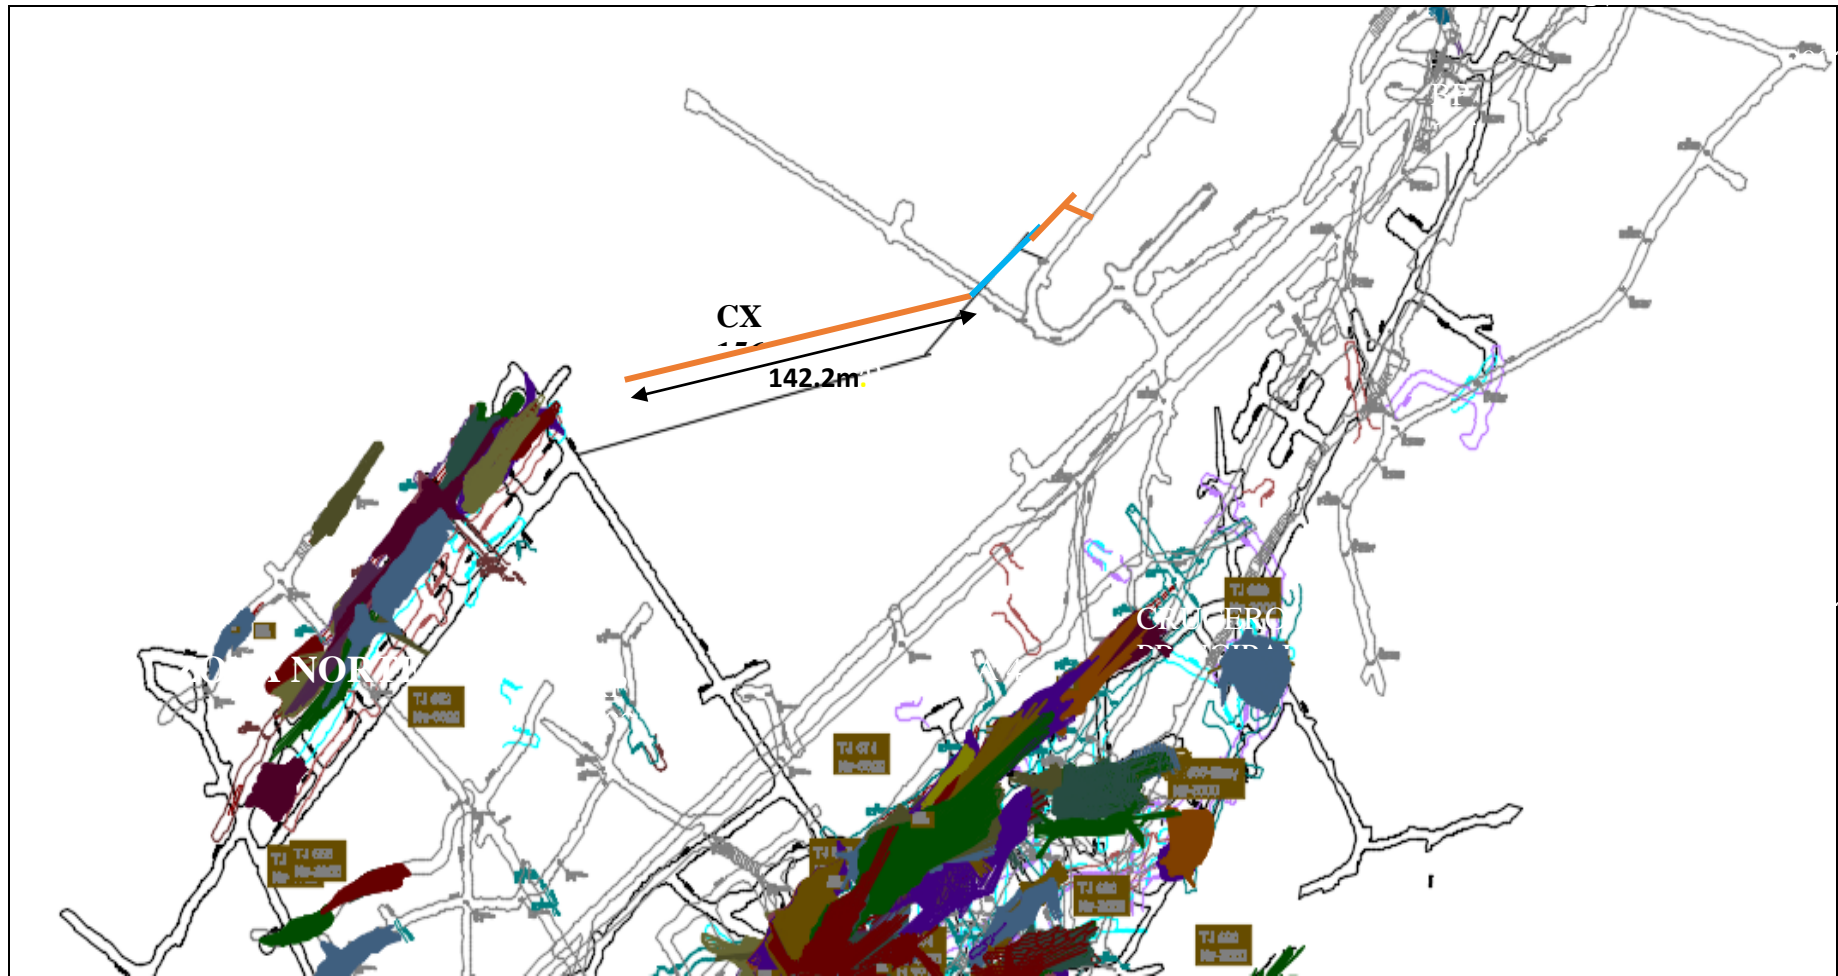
Vista en planta – Proyecto Chimenea Alimak 156.
